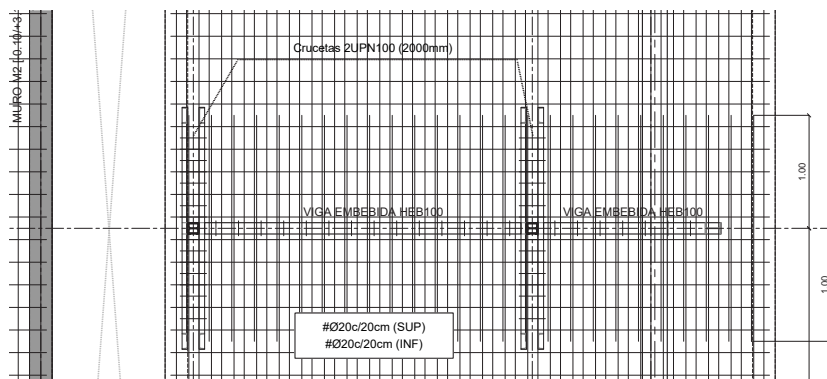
Detalle pilares en planta. [Fuente: Estructuras Singulares | UPV]
